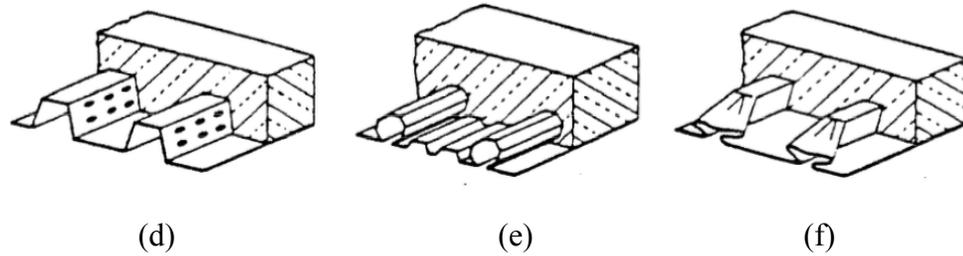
Variantes de solidarización chapa metálica – hormigón
